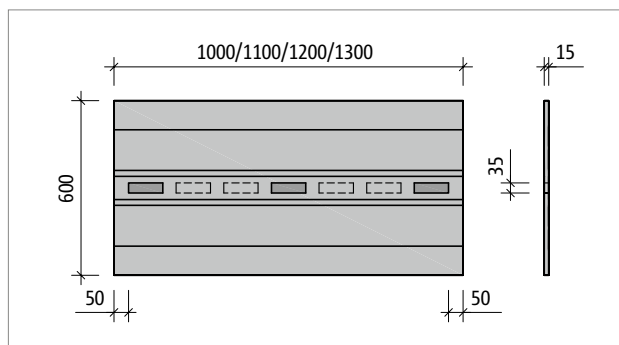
Schöck Tronsole® Typ B-V1...-B600: Produktgrundriss
